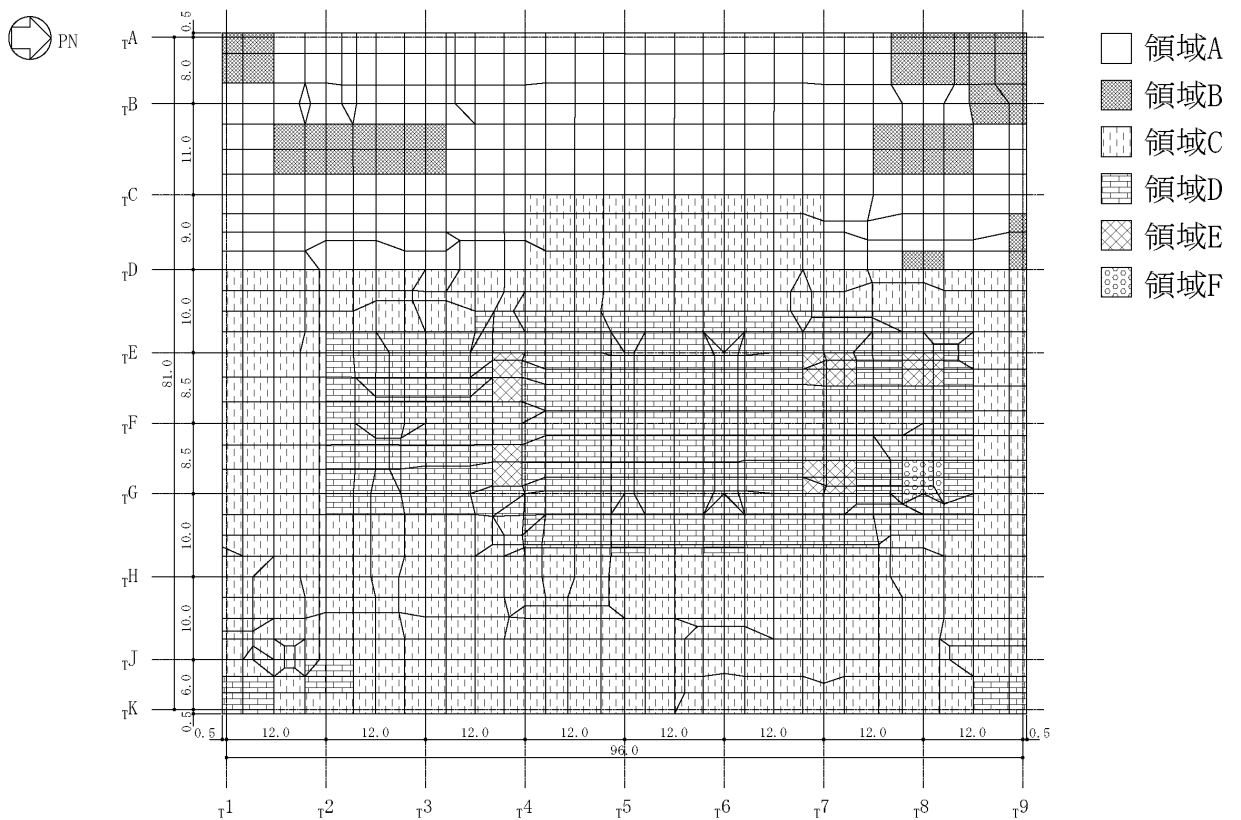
基礎スラブの配筋領域図 (EW 方向, 上ば筋) (単位 : m)
